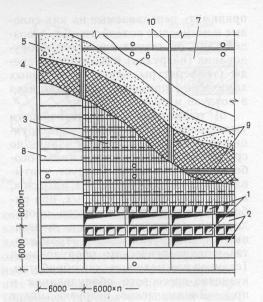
Устройство легкосбрасываемого покрытия. План I — железобетонные плиты с проемами; 2 — проемы между плитами; 3 — волнистые асбестоцементные листы; 4 — теплоизоляция; 5 — цементная стяжка; 6 — рулонный гидроизоляционный ковер; 7 — защитный слой (посыпка гравием); 8 — обычные железобетонные плиты покрытия; 9 — асбестоцементные уголки; 10 — деформационные швы
